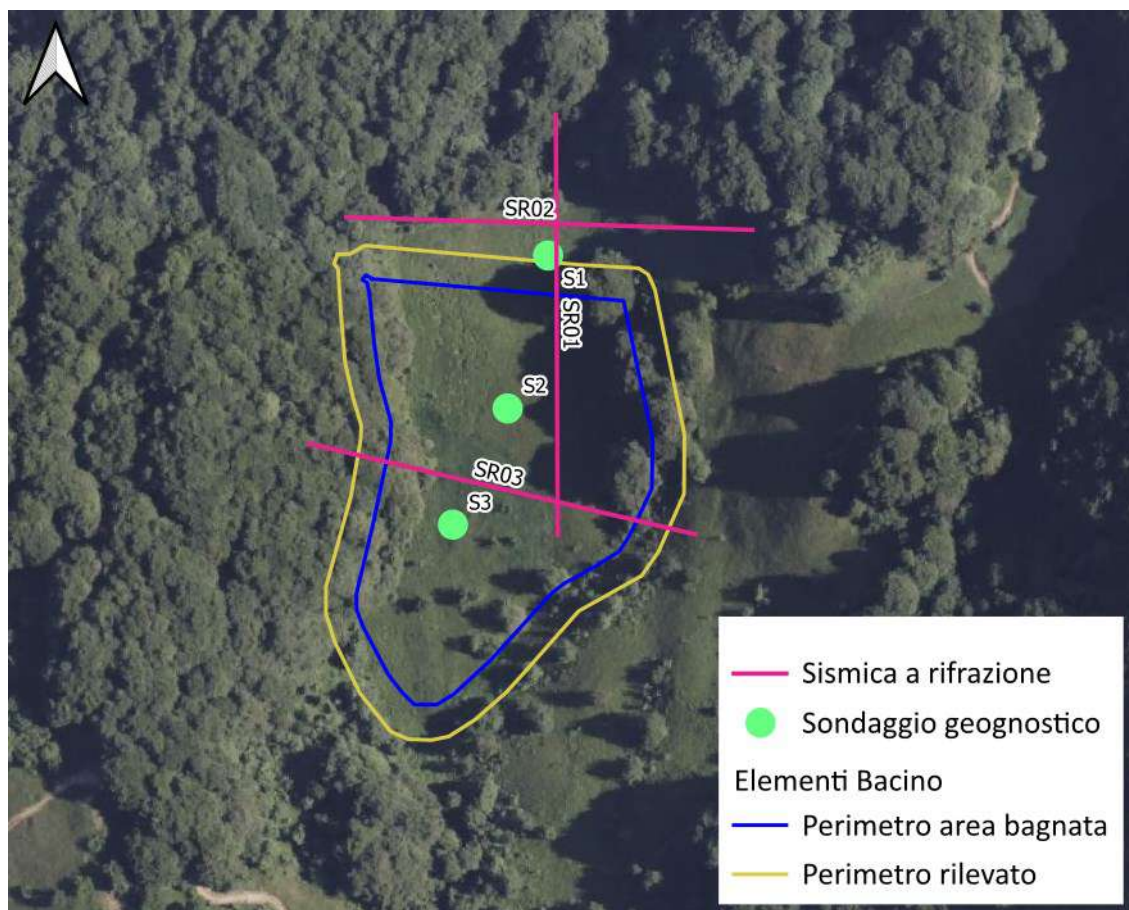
Planimetria opera in progetto con ubicazione delle indagini
